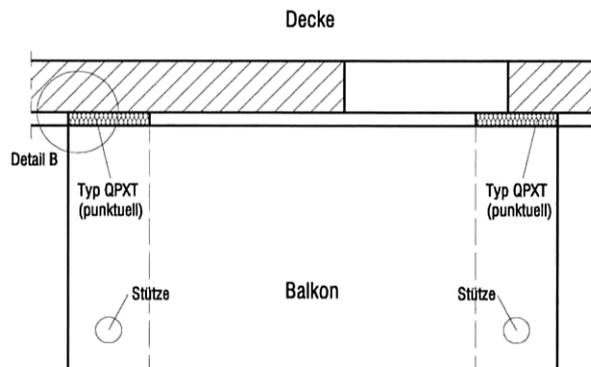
Einbausituation Schöck Isokorb Typ QPXT
